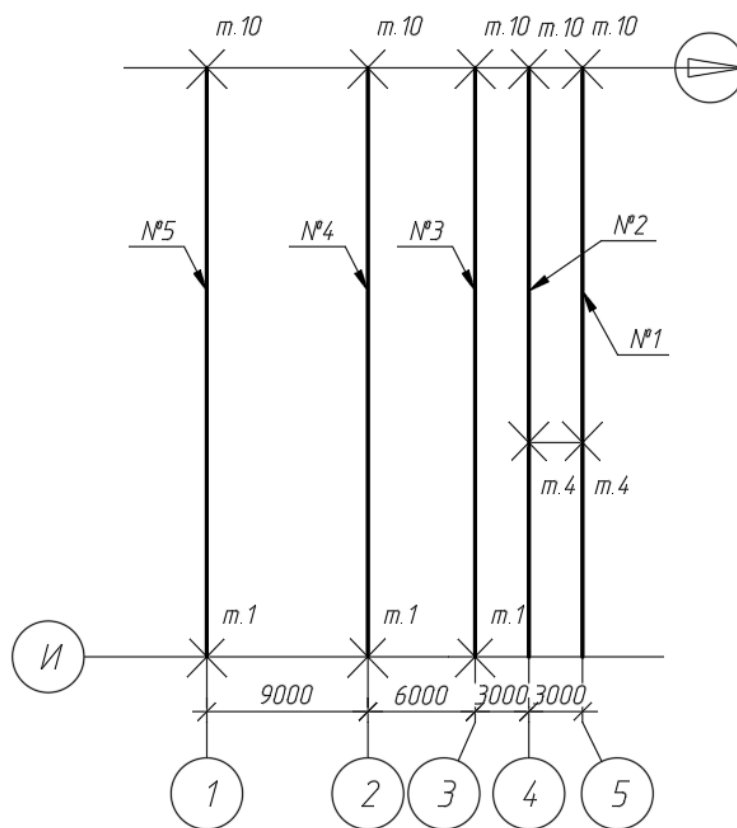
Схема расположения арочных конструкций блока Г и Д
